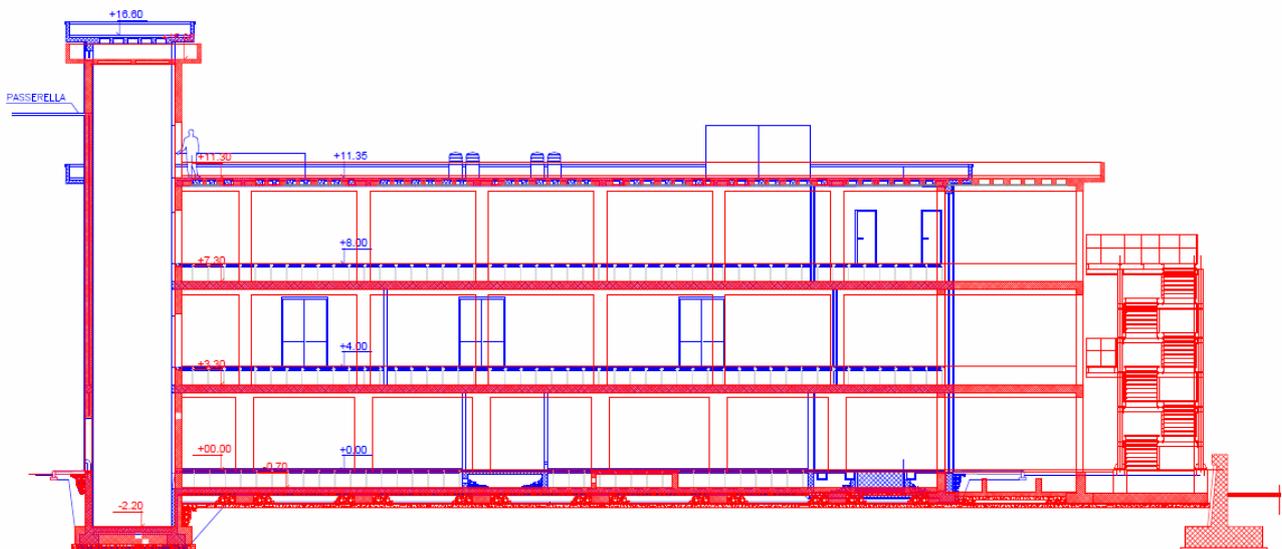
Sezione longitudinale del fabbricato nel Progetto approvato.
